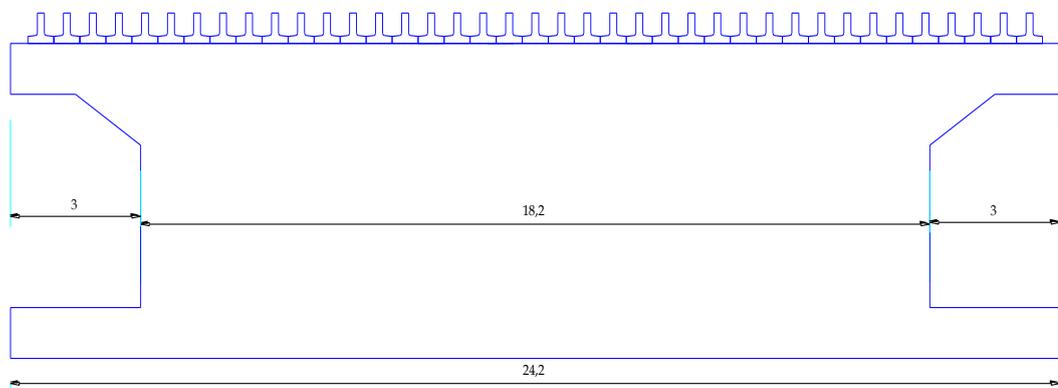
DETALLES DE PILA CENTRAL PROPUESTA EN LA RECONSTRUCCIÓN DEL PUENTE 17 DE SEPTIEMBRE.
